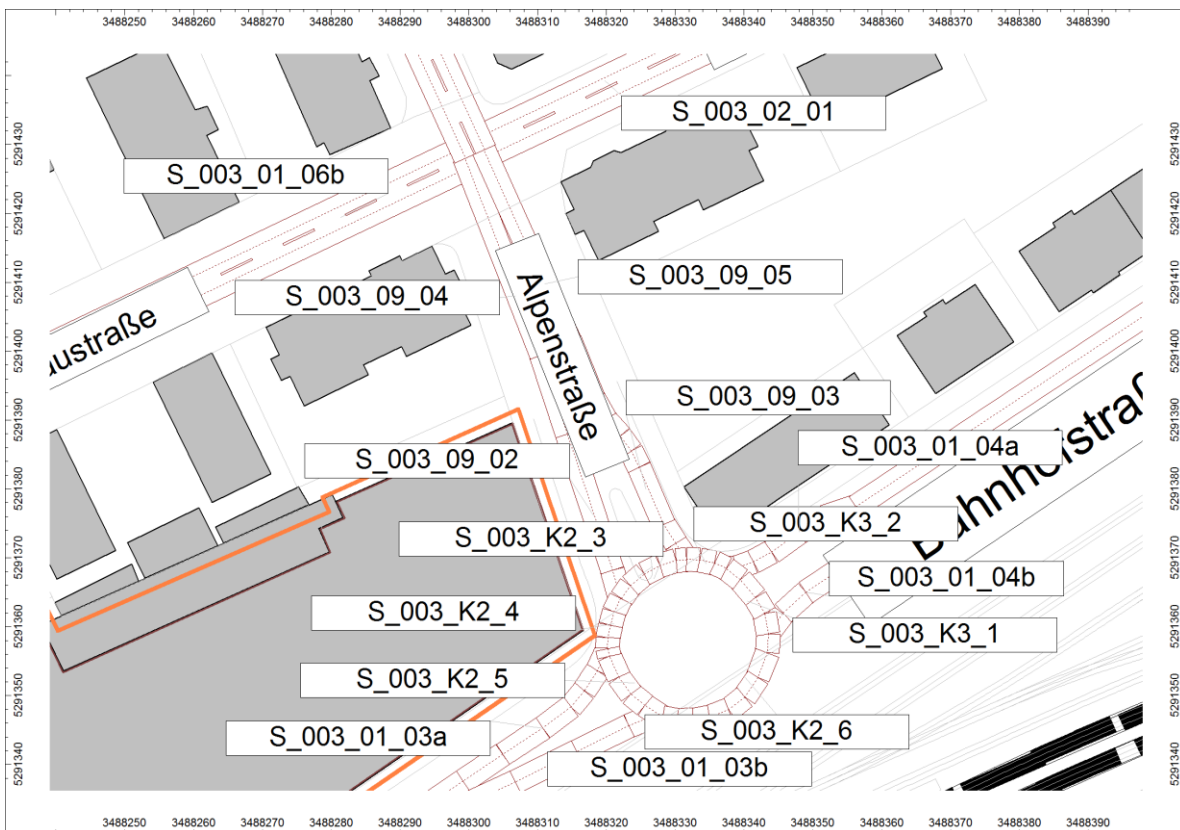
Beispielhafter Lageplan mit Abschnittsbezeichnung der Straßen im Prognose Planfall 2030
